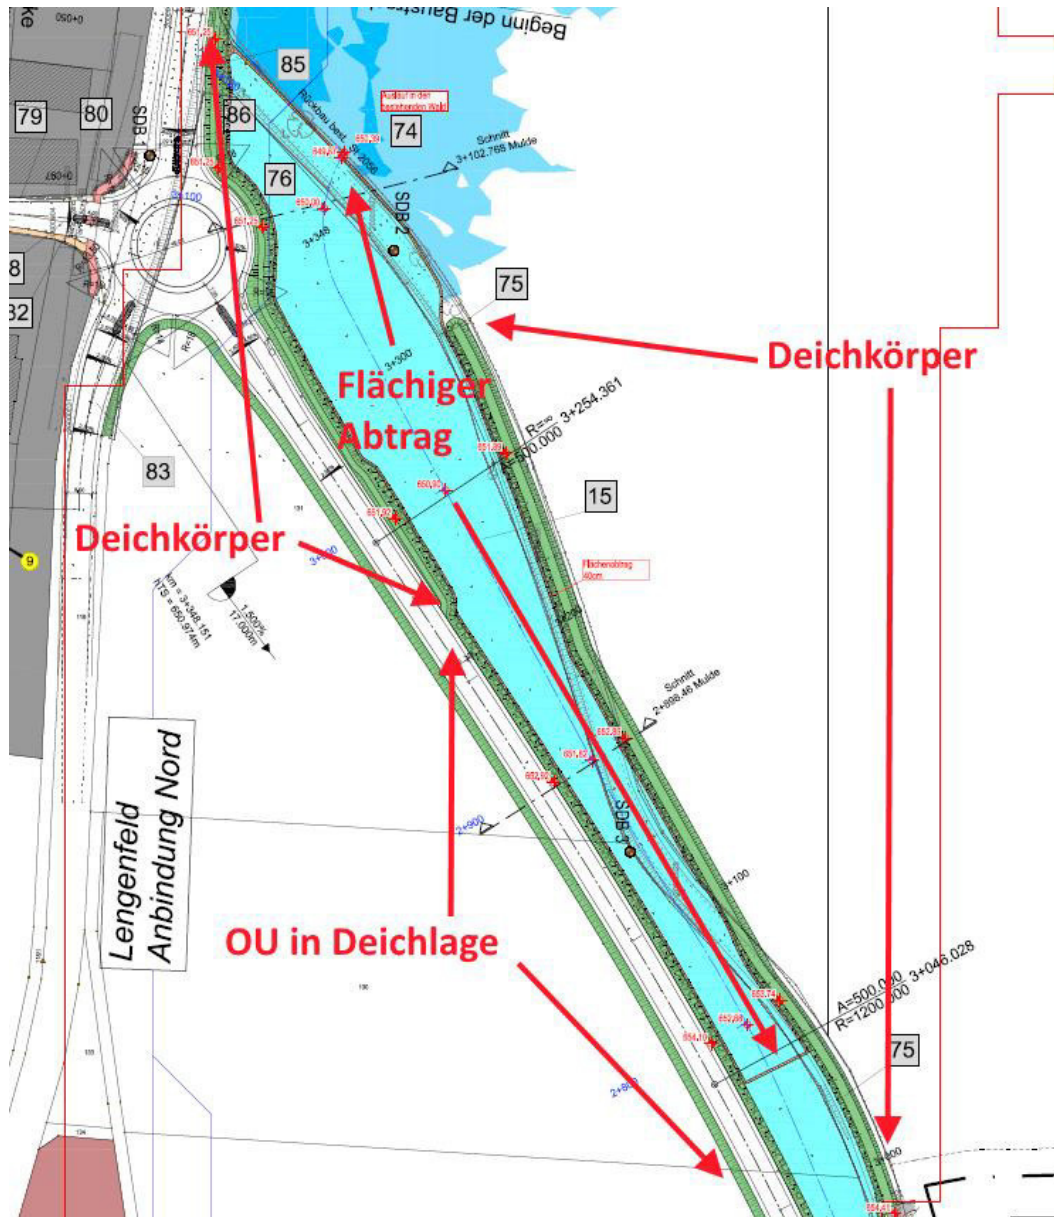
Lageplanausschnitt (Unterlage 18B 2.5) Maßnahmen im letzten Muldenabschnitt zur Verhinderung von Ausuferungen in die westlich angrenzende Bebauung und dem östlich angrenzende Hofstetter Frauenwald
